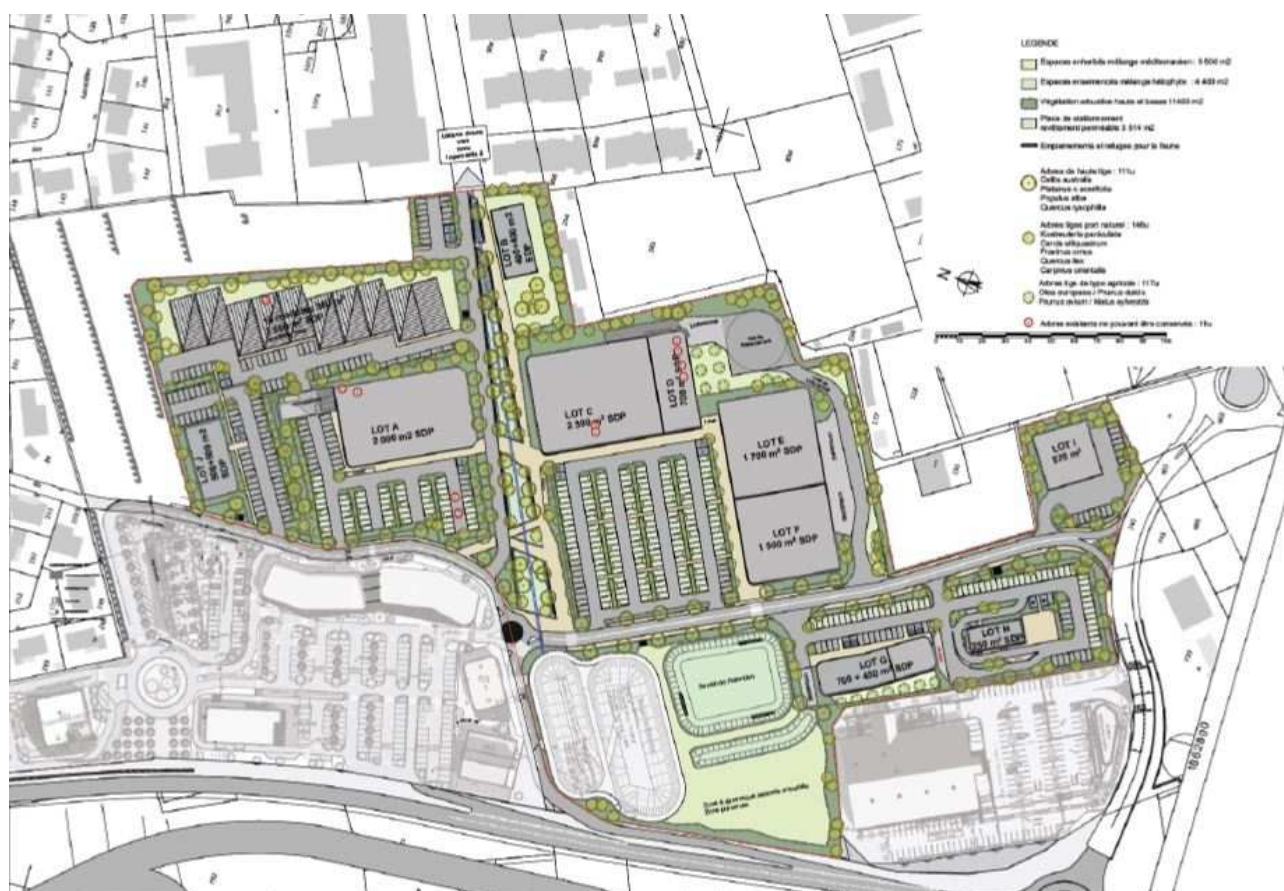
plan d'aménagement paysager. Source : étude d'impact.
